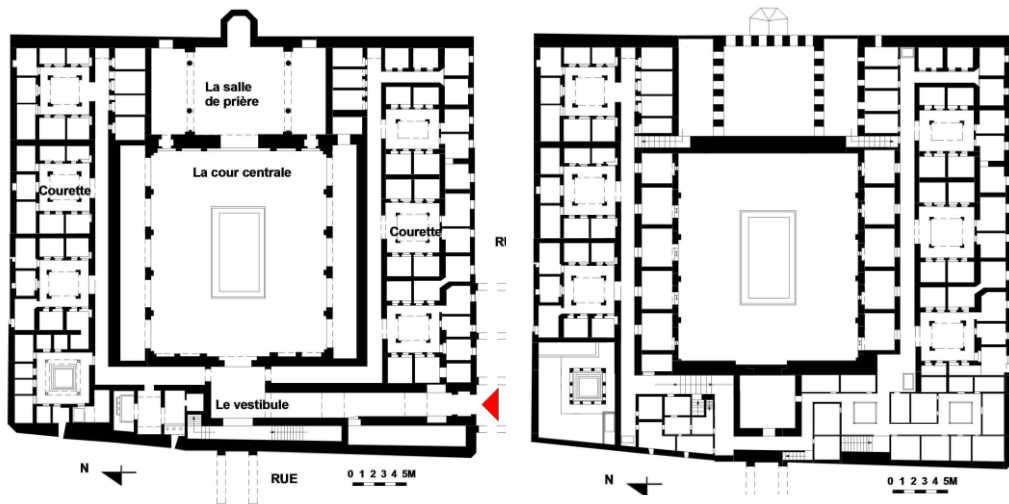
Vues en plan de rez-de-chaussée (à gauche) et de l'étage (à droite) de la medersa de Ben Youssef à Marrakech
